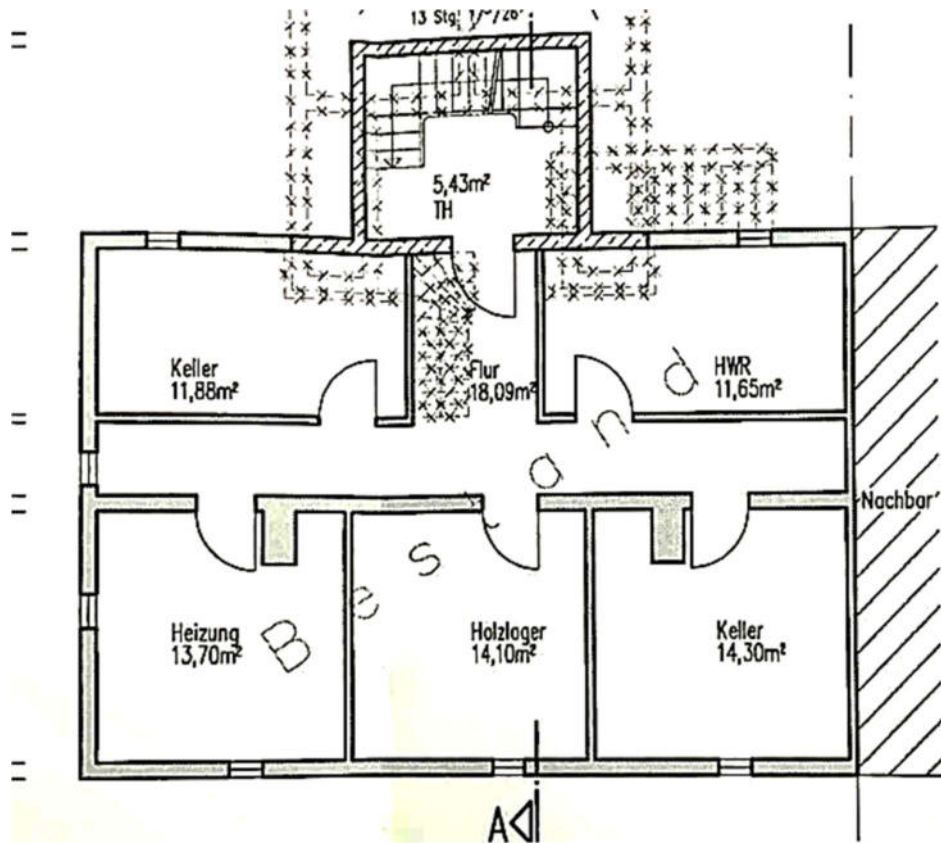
Grundriss Kellergeschoss (Bauunterlagen 2006)
